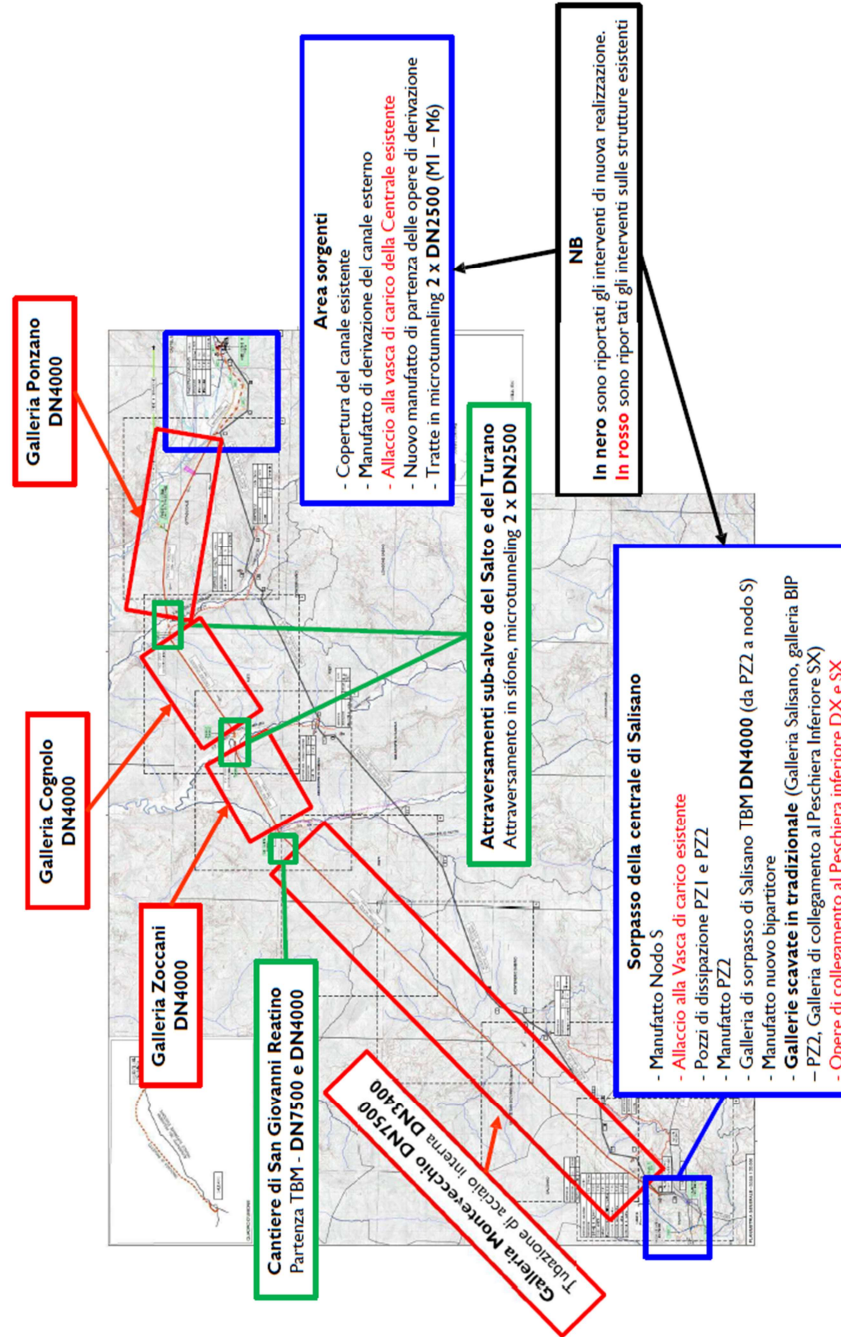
Nuovo Tronco Superiore dell’Acquedotto del Peschiera - Planimetria generale delle opere in progetto
